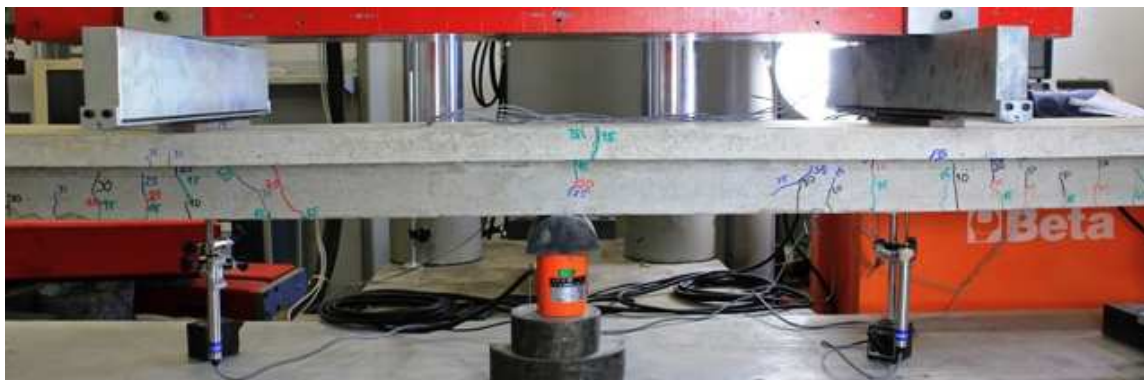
Padrão de fissuras na viga G3-a para a carga de 40 kN
